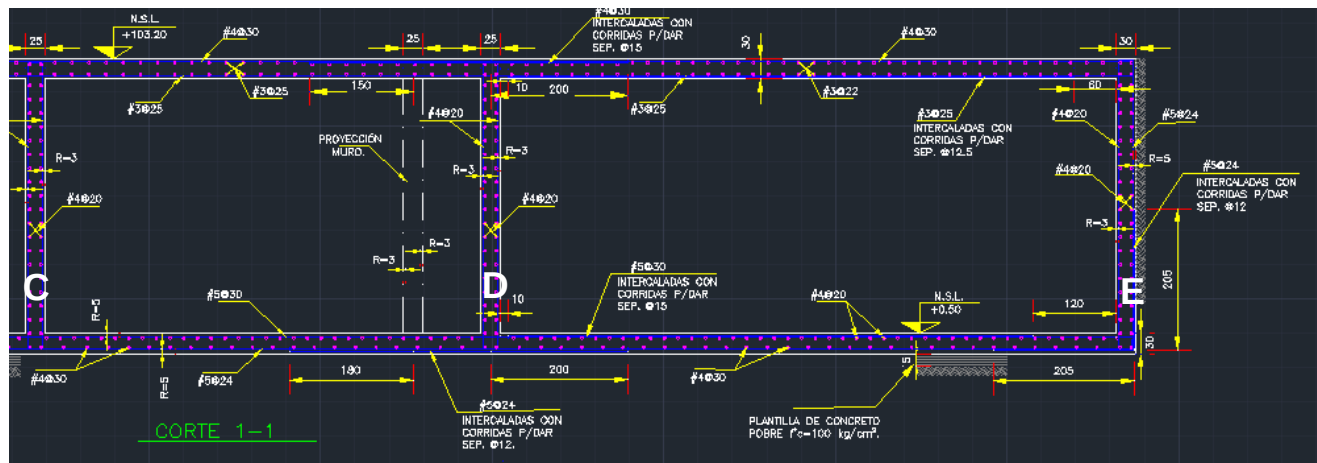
Armado de los muros en el corte 1-1 en cuarto de máquinas.
